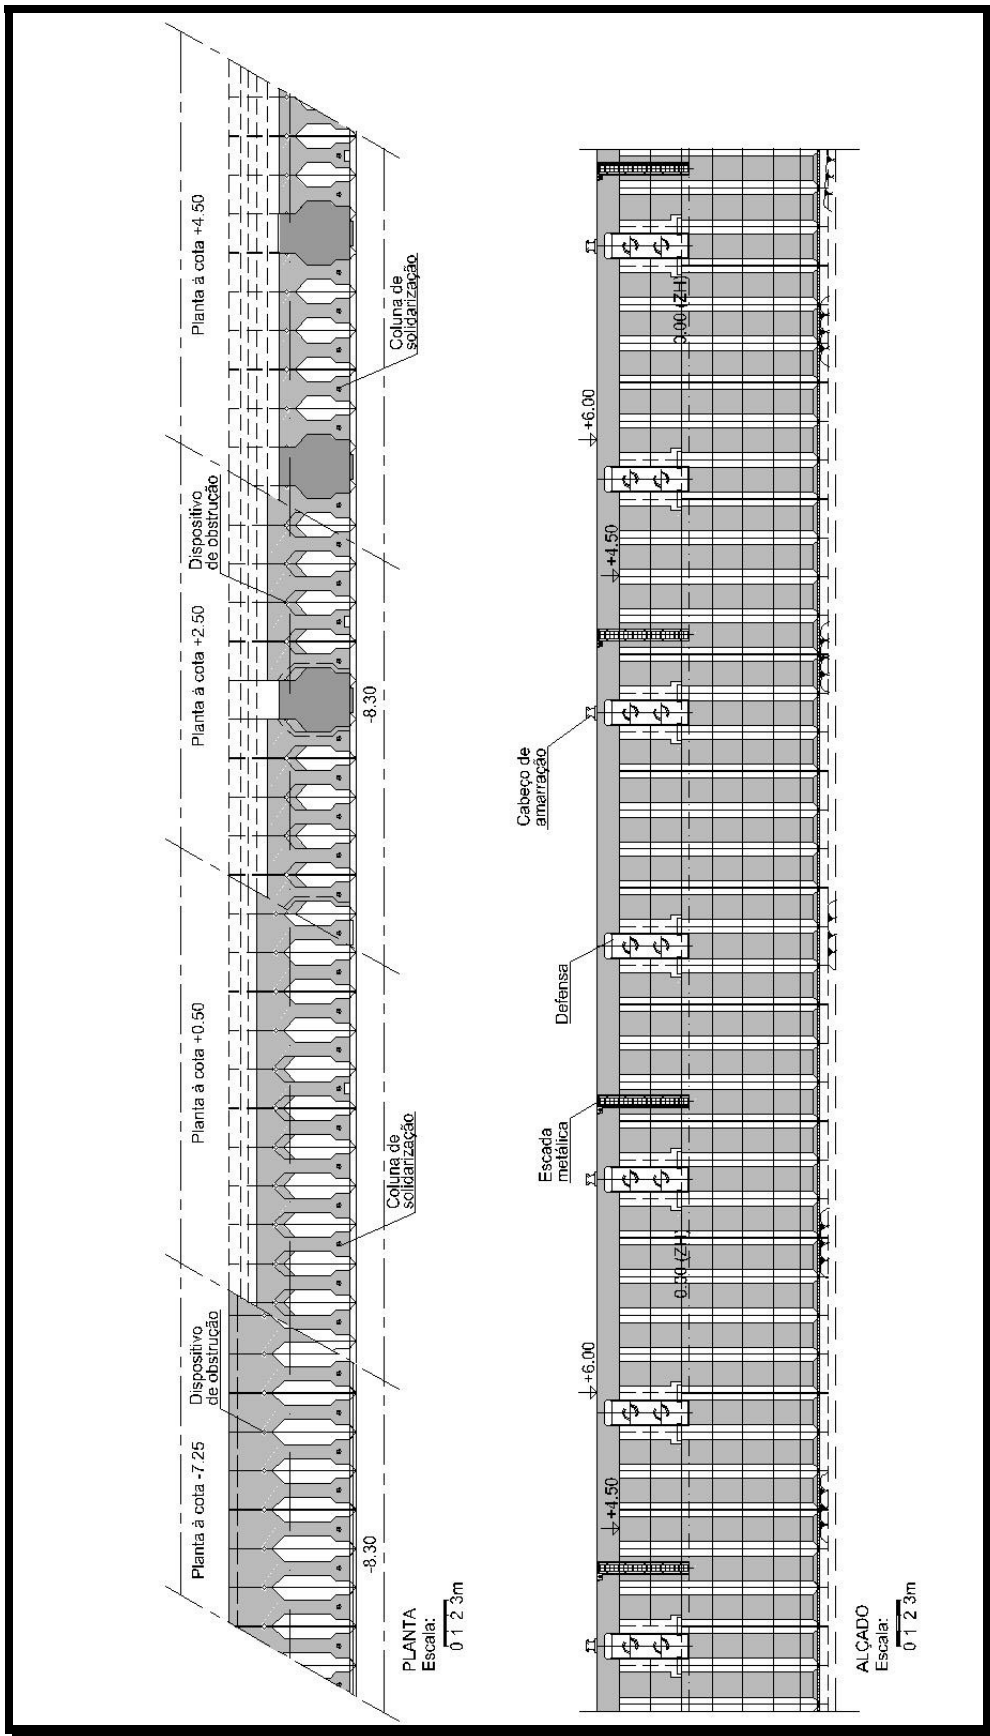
b) – Planta e alçado do muro-cais em Blocos NOREF
